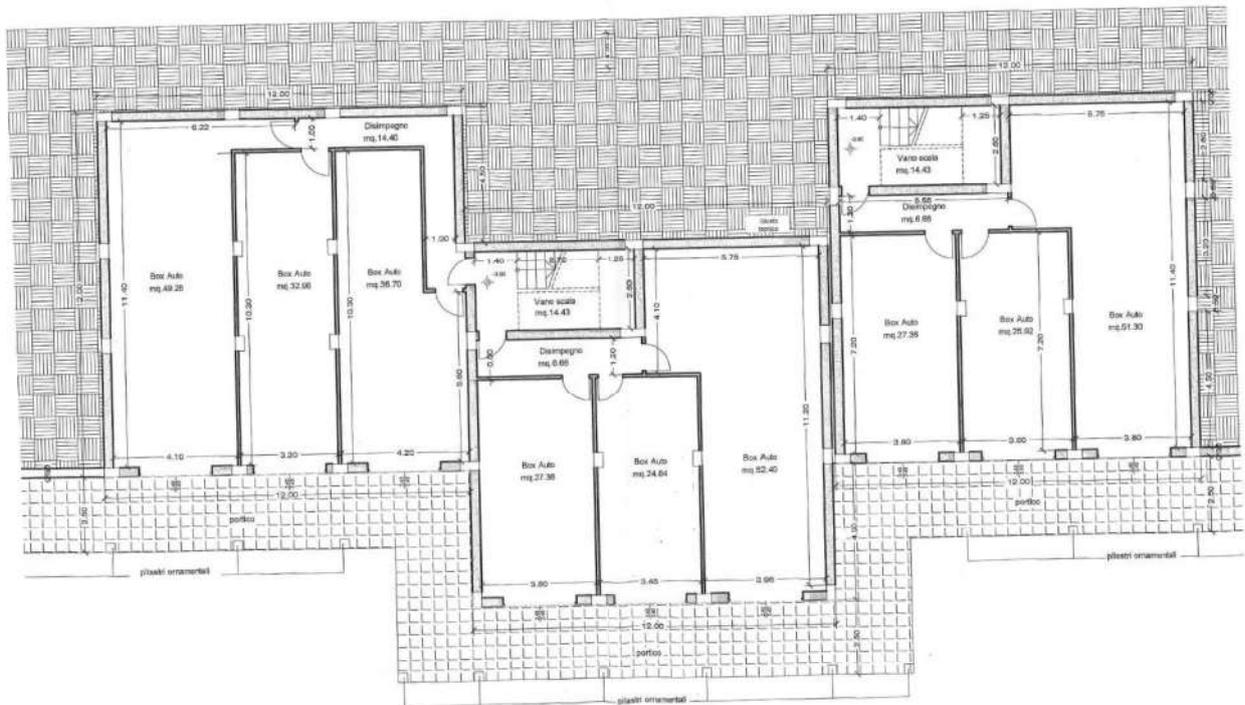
Pianta piano S1° (F. ■ p.lla ■ sub. ■) allegata alla S.C.I.A. - Prot. n. ■ del 10.2.2011 (garage)
